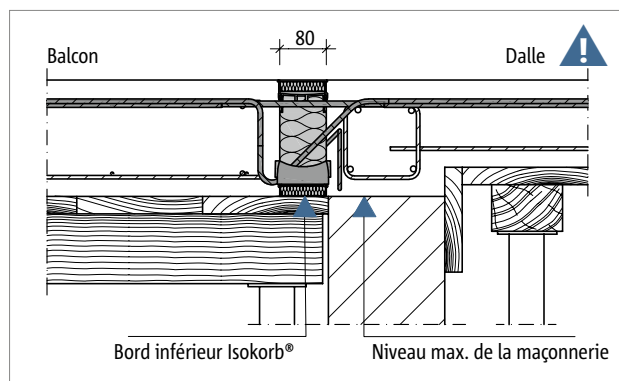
Schöck Isokorb® T Type K-E, K-T : Balcon en béton coulé sur place avec plancher surélevé sur mur en maçonnerie
